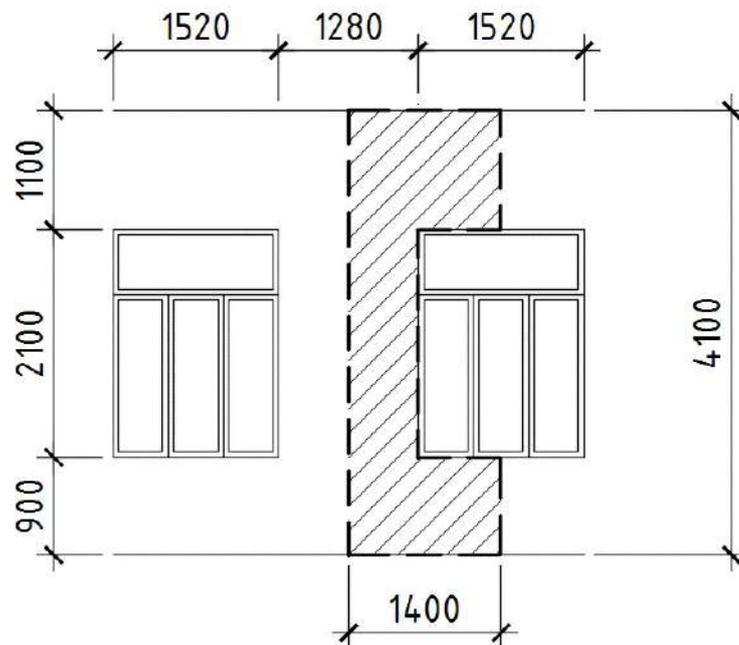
Фрагмент фасаду з розрахунковою ділянкою
